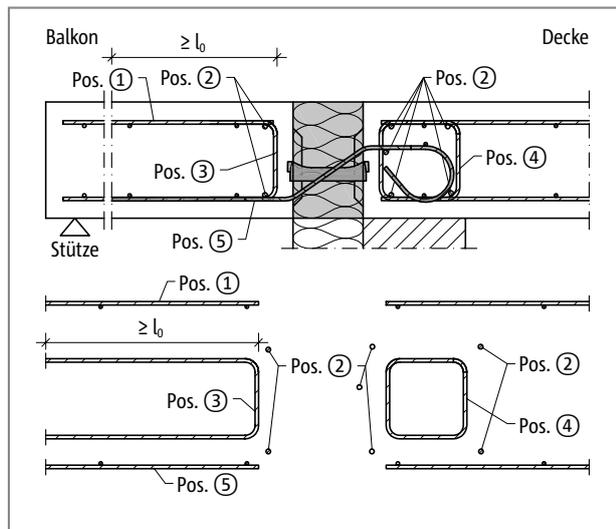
Schöck Isokorb® Typ QXT10 bis QXT40: Bauseitige Bewehrung
